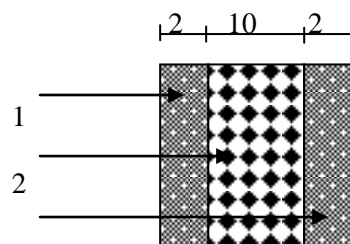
Coupe verticale d'un mur extérieur
